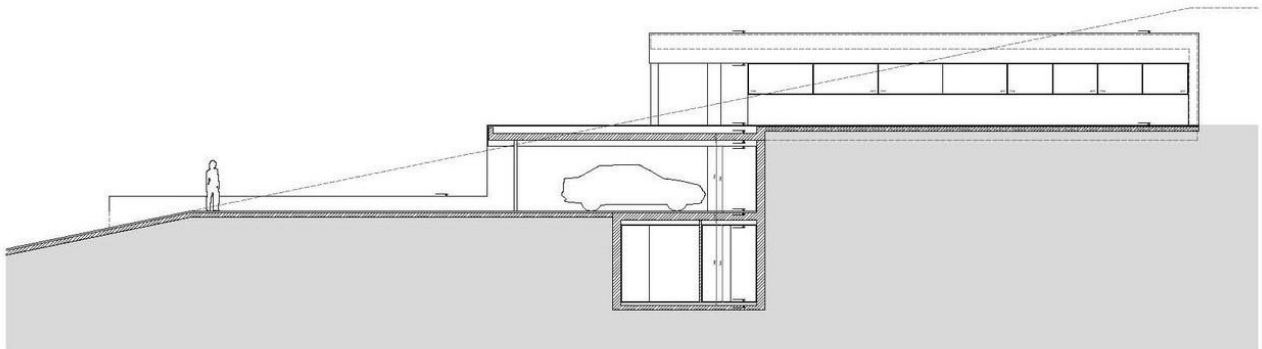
Alzado noroeste. Fuente: Fran Silvestre Arquitectos.
